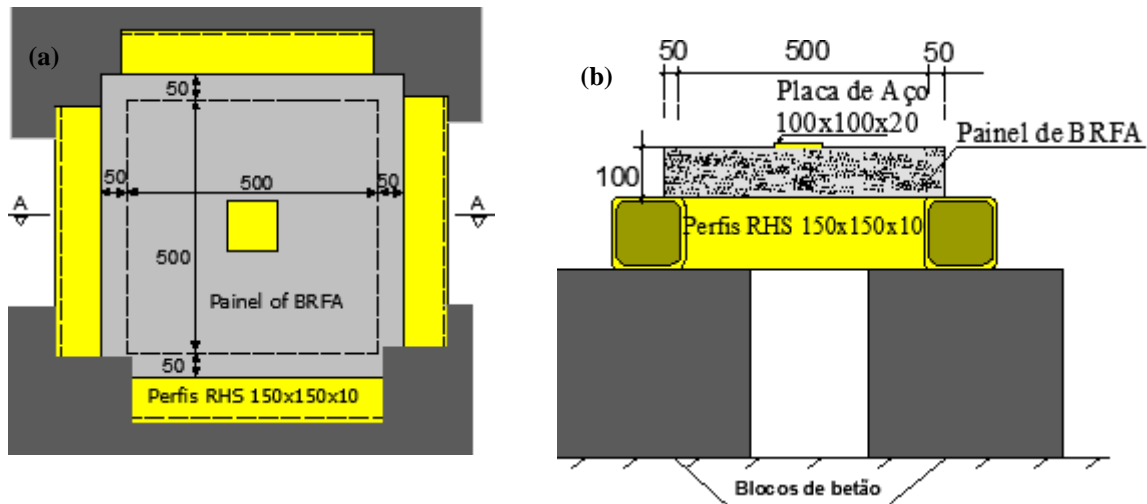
Painel apoiado no sistema de apoio, (a) vista em planta e (b) vista pelo corte A-A, (desenho sem escala e dimensões em mm).
